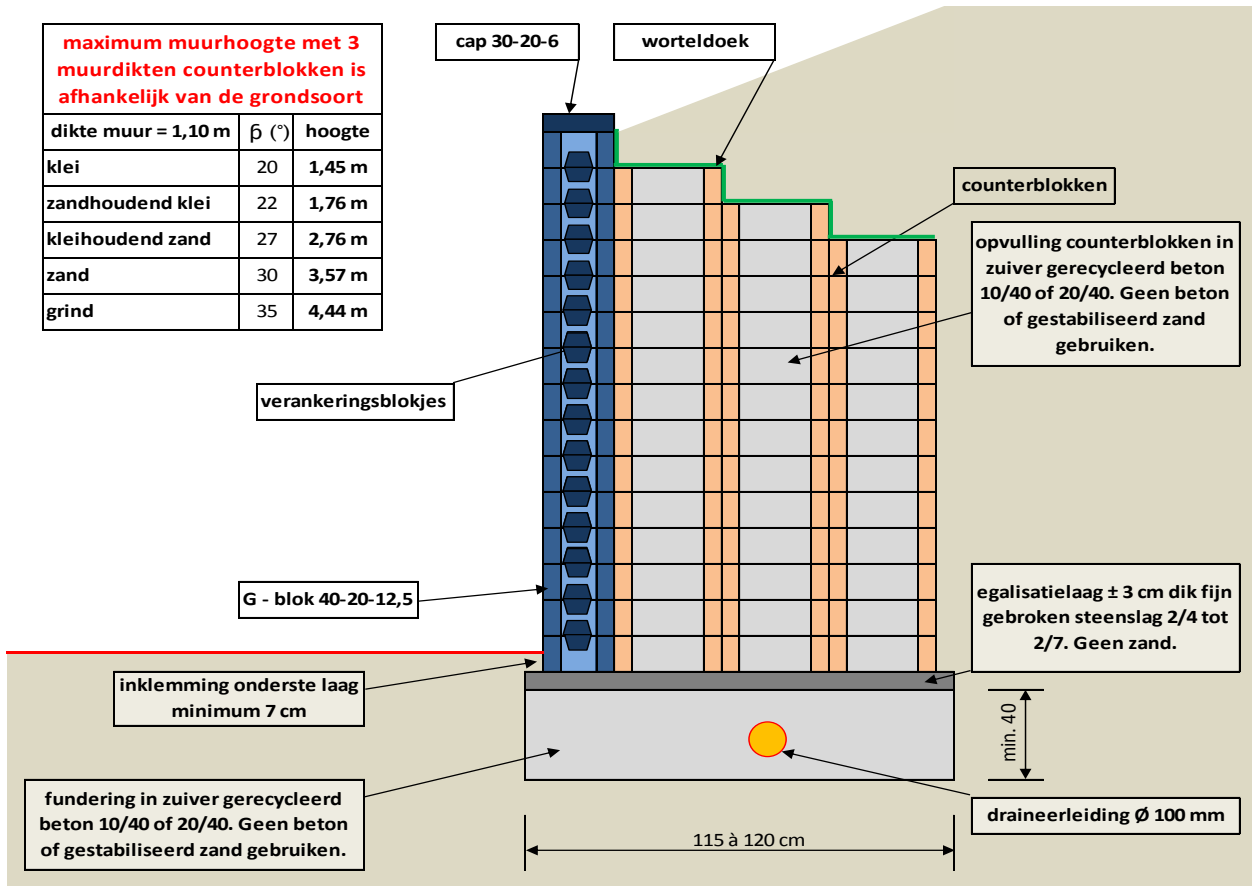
DETAILS GRONDKERING MET ACHTERLIGGENDE HELLING 3/1
